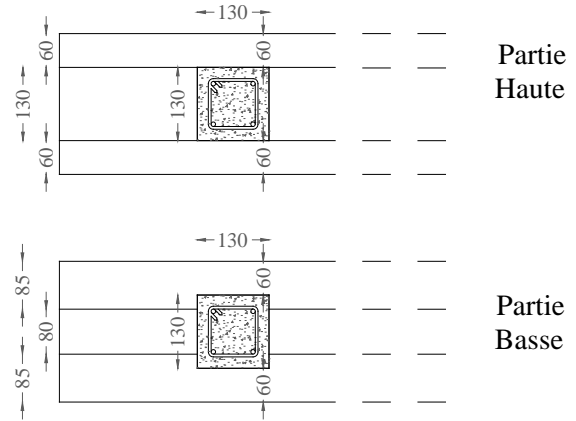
Détail 3 en plan avec le ferrailage vertical
